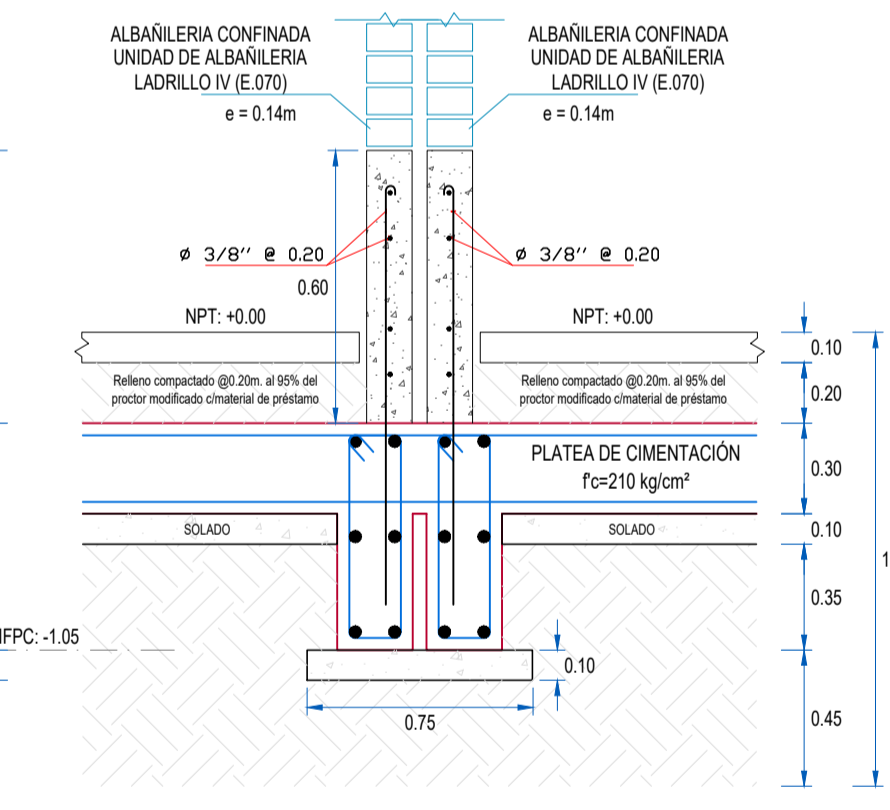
PLATEA DE CIMENTACIÓN (CORTE 1-1)
